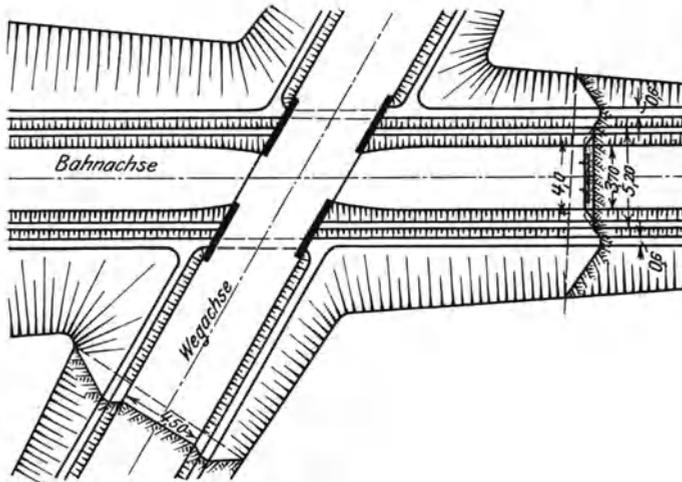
Wegübergang in Schienenhöhe im Einschnitt mit Durchlässen.
